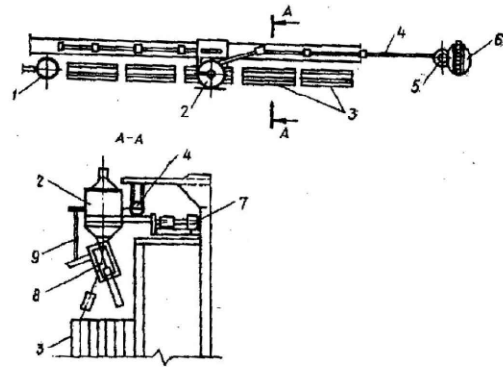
Схема пневмоподавання бетонної суміші: 1 – приймальна камера поста промивання; 2 – самохідний бетонороздавач; 3 – касети; 4 – бетоновод; 5 – камерний живильник; 6 – бетонозмичувач; 7 – візок бетонороздавача; 8 – механізм поздовжнього пересування протічки; 9 – механізм поперечного пересування протічки.
